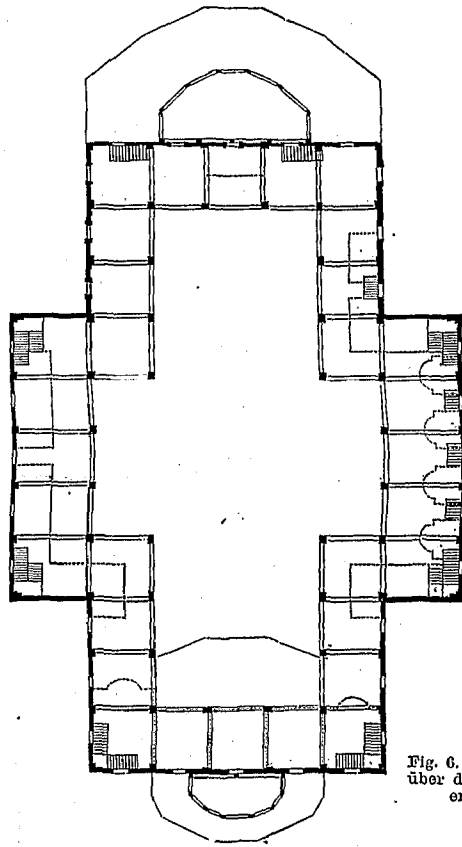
Grundriss über der I. Hauptempore.
